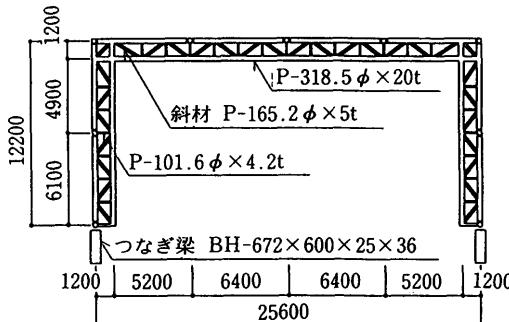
南側ガラスキューブ 平面図 (7, 14m位置)
